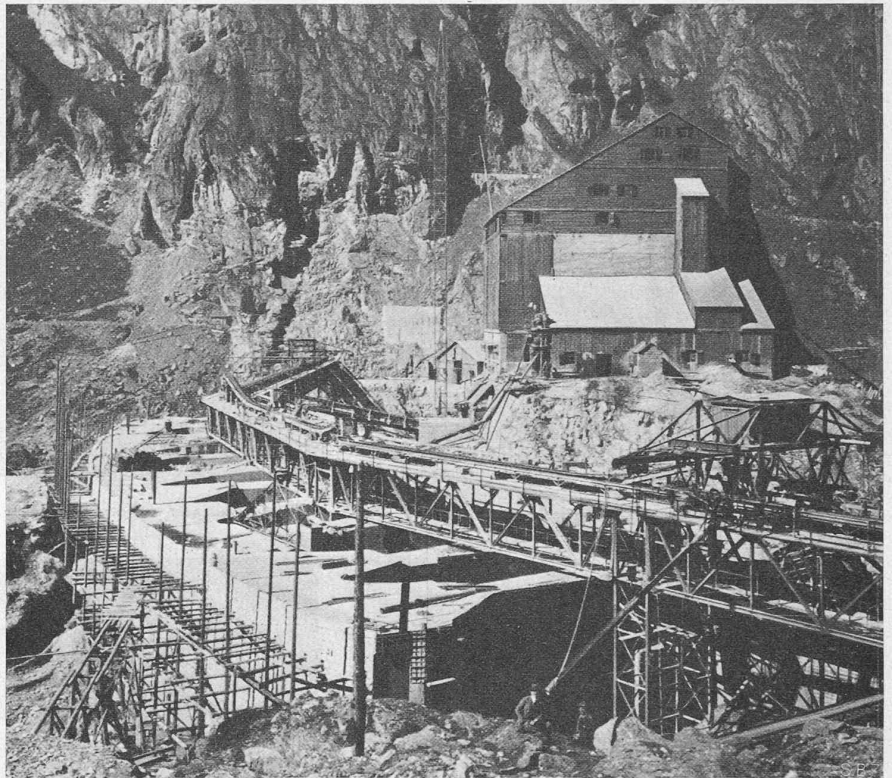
Bauzustand der Mauer Anfang Oktober, Blick aus Osten gegen die linke Talflanke.
